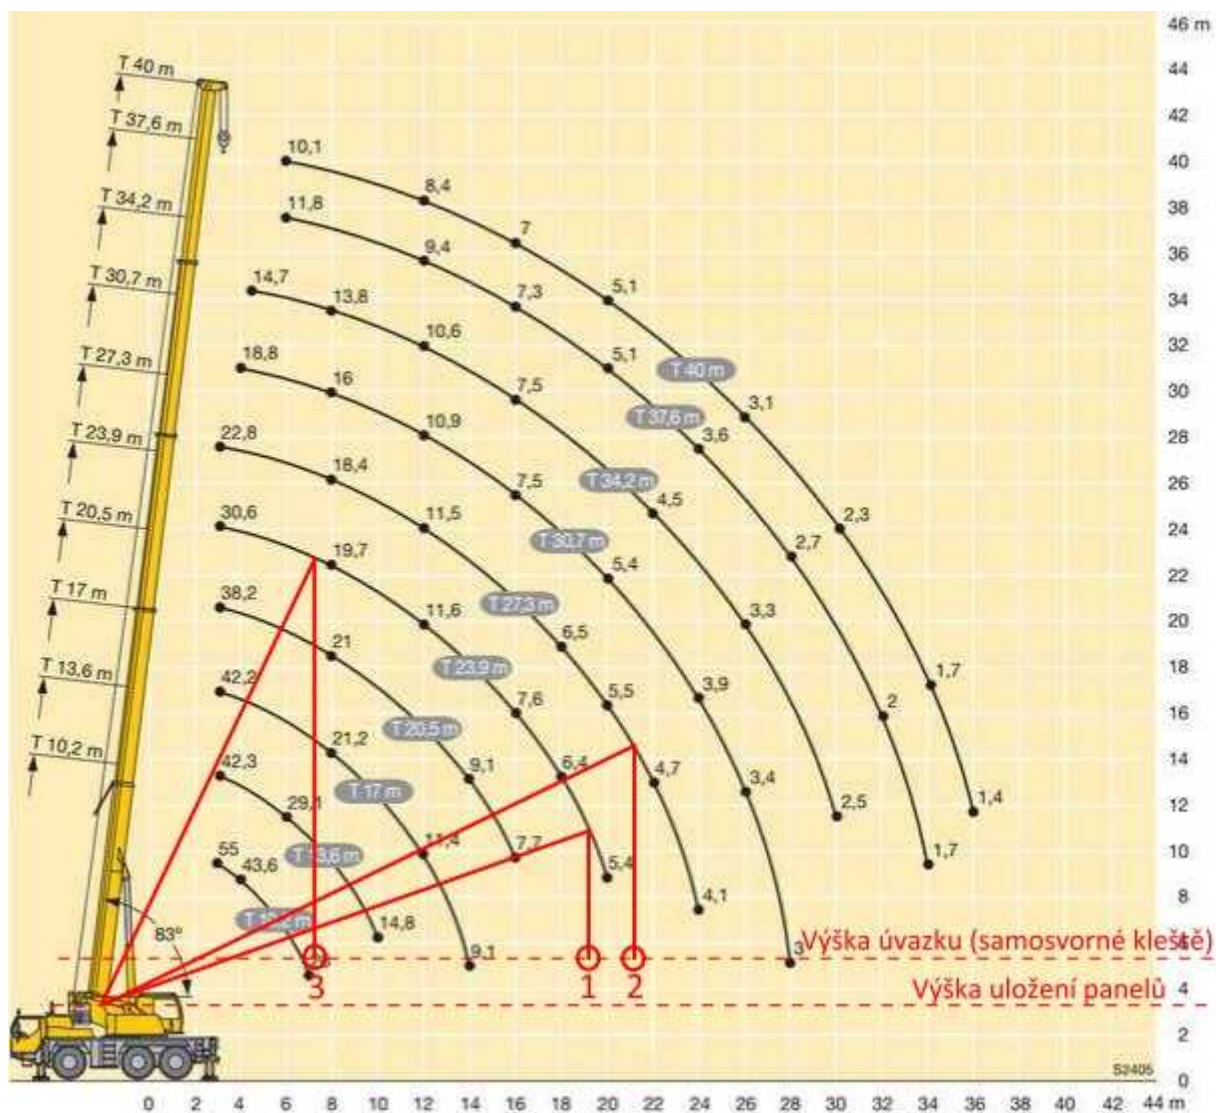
Autojeřáb Leibherr LTM 1055/1 [29]
